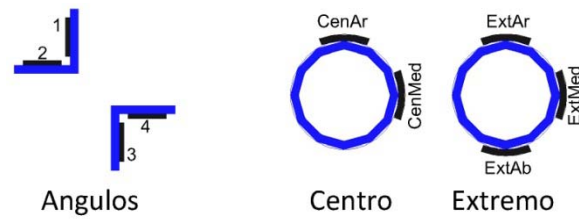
Colocación de deformímetros eléctricos (Strain Gages)
